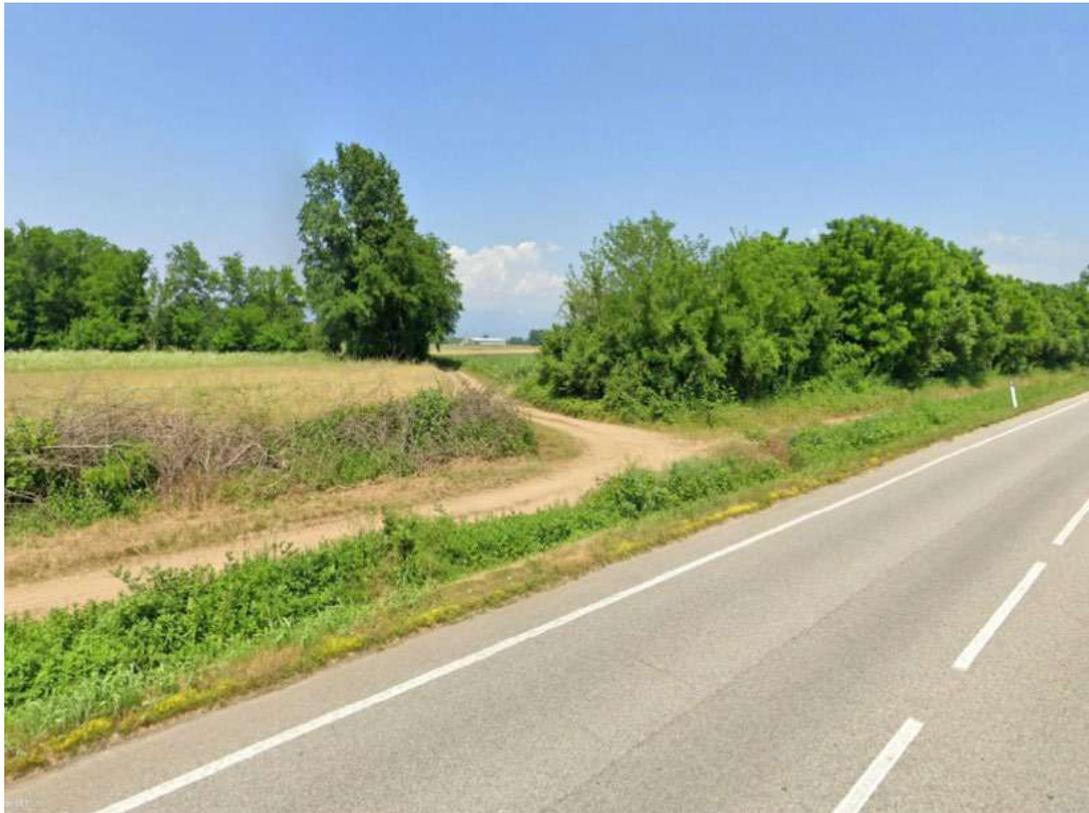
Punto di scatto n°10 Stato di Fatto :L'area d'intervento vista dalla SP60 direzione Udine
